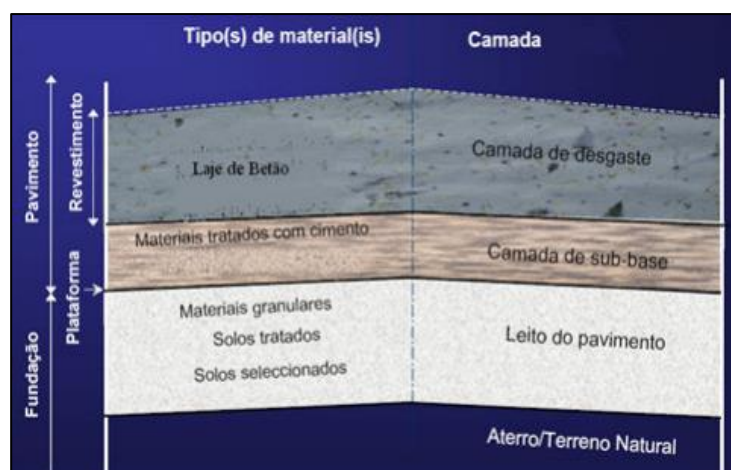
Estrutura de um pavimento rígido (Reis, op. cit.)
